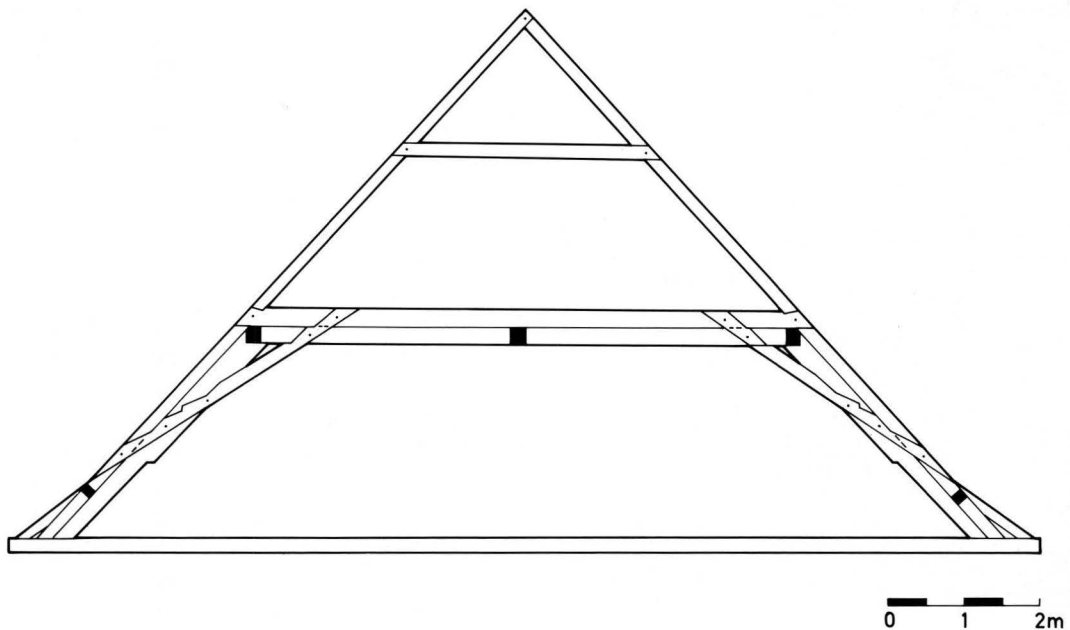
Bäumleingasse 14. Dachstuhl. Schnitt mit Blick nach Osten. Dendrodatiert 1497. – Umzeichnung: F. Goldschmidt nach Aufnahme von U. Lareida. – Masstab 1: 100.
